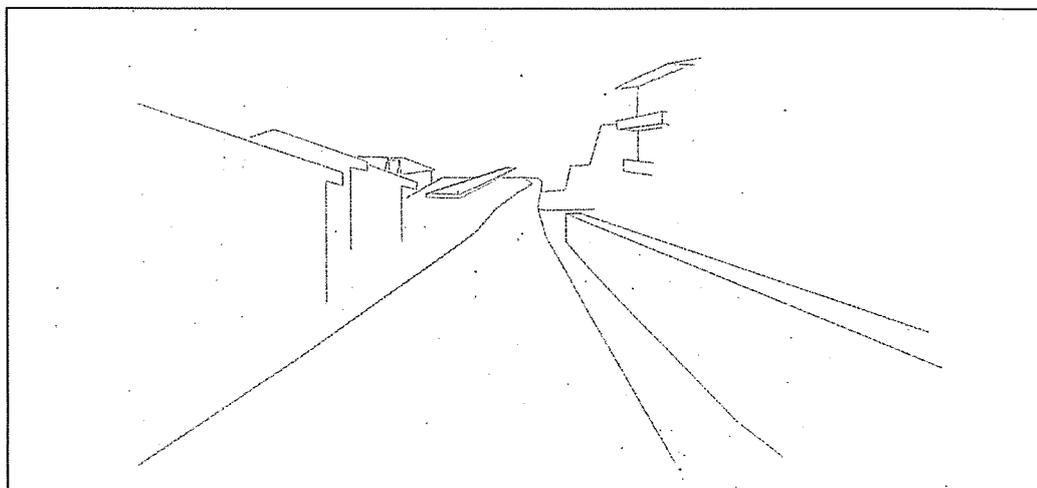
Bozzetto della pensilina, vista dalla Chiesa.
